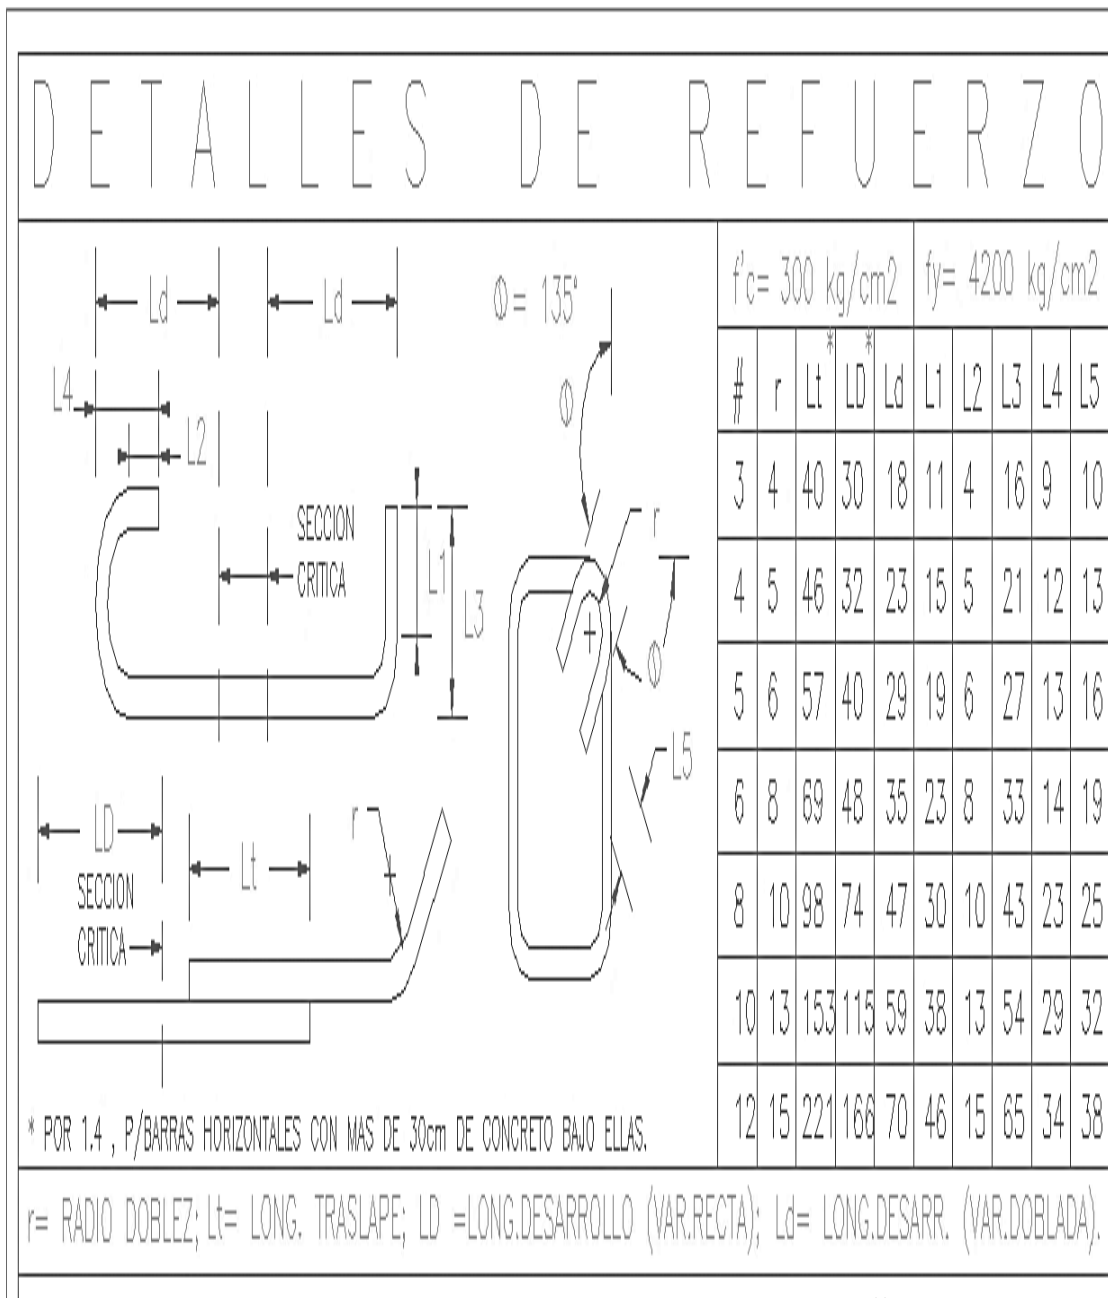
PLANO ESTRUCTURAL DE PARAPETOS.
